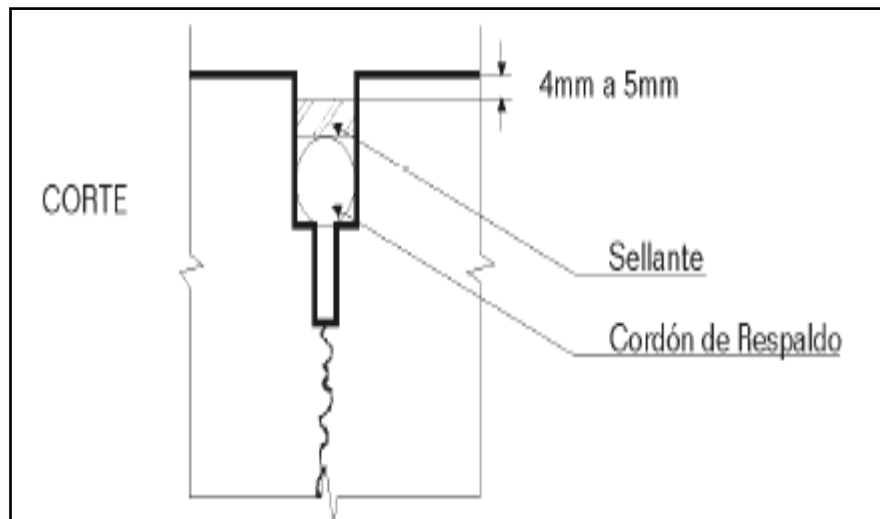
Corte- Fuente (Deterioros en pavimentos flexibles y rígidos)- Ricardo Javier Miranda Rebolledo Valdivia – Chile – 2010
